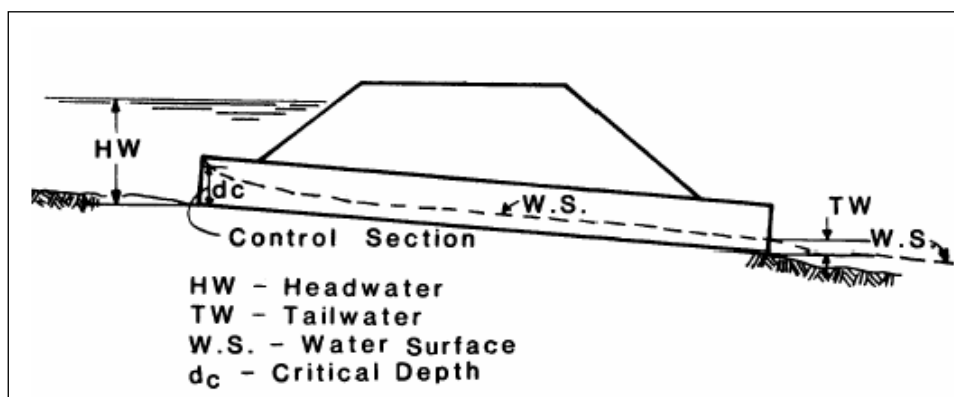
Esempio di moto controllato dalla sezione di ingresso.
